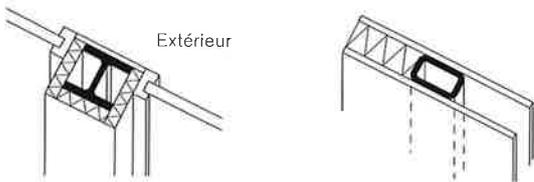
Façades ou parois servant de revêtement ou écran anti-feu pour les poteaux intégrés
